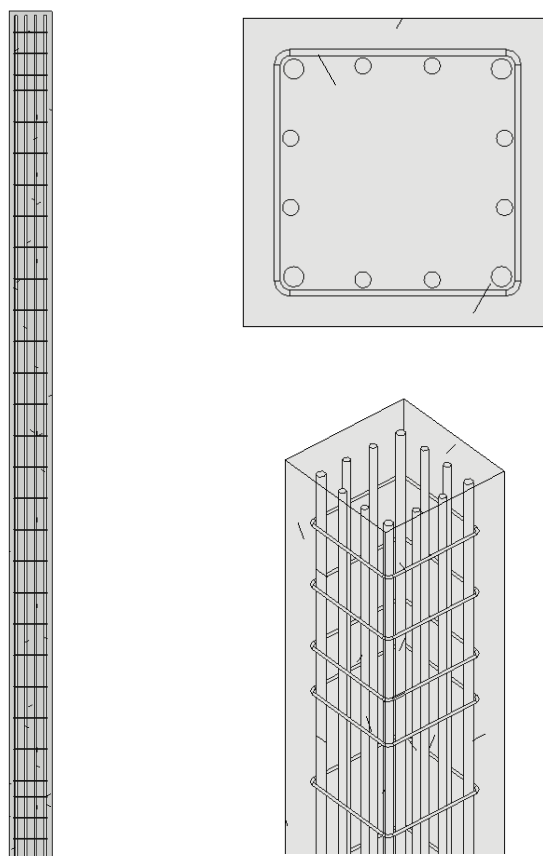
Vistas e modelo 3D de um pilar com armaduras
